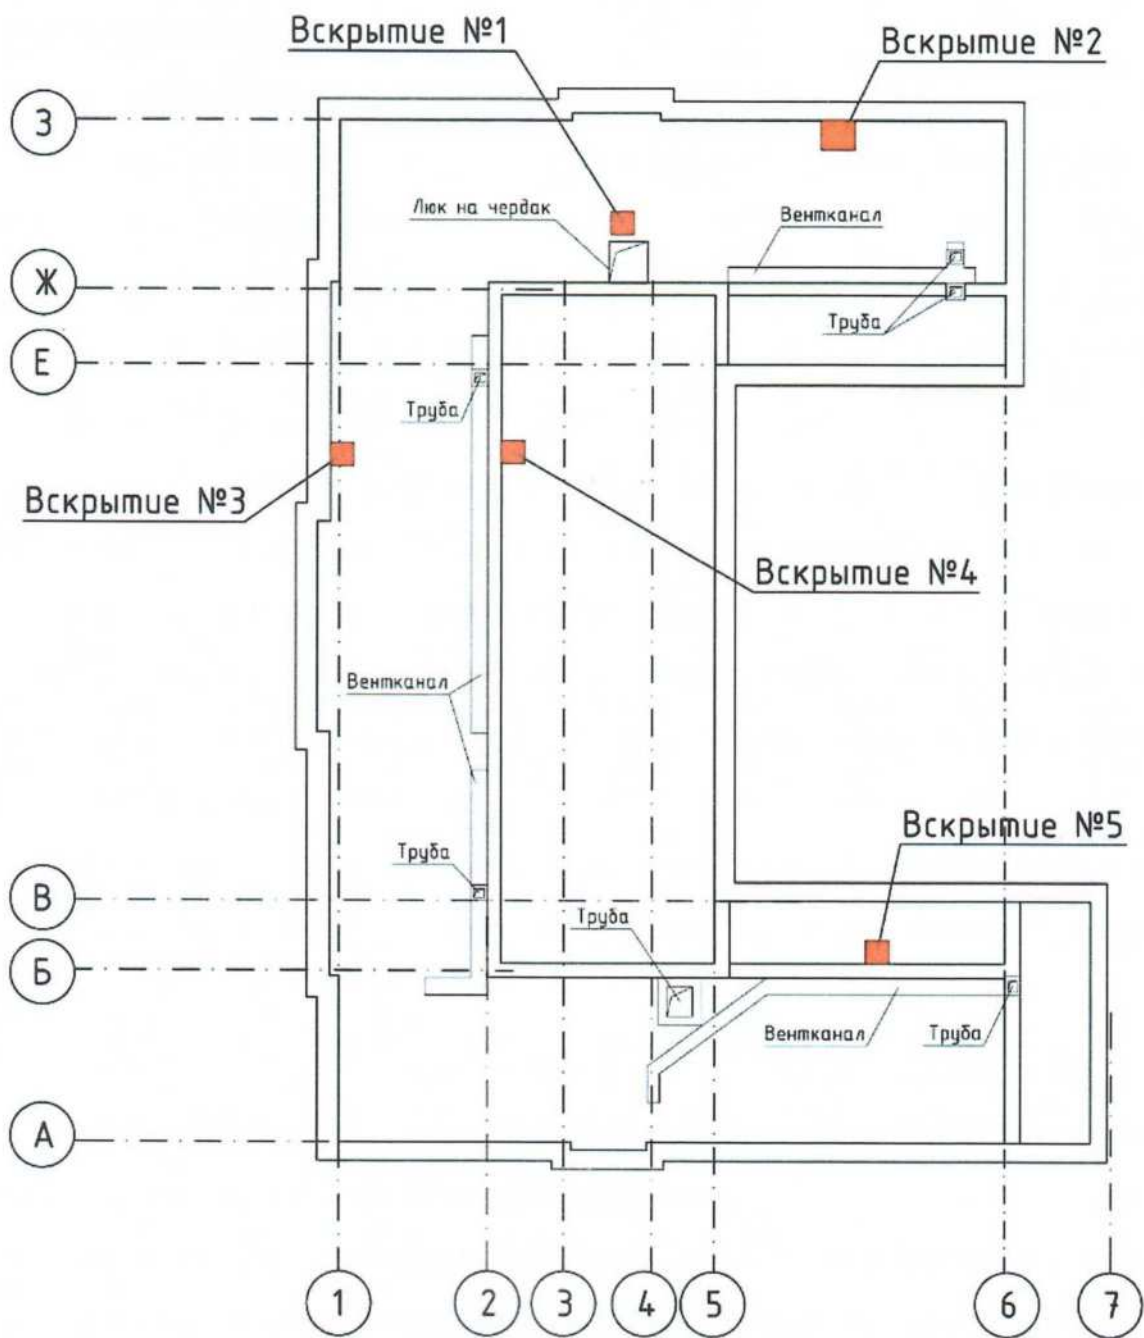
Местоположение вскрытий перекрытия 2-го этажа (чердачное перекрытие) на плане чердака
